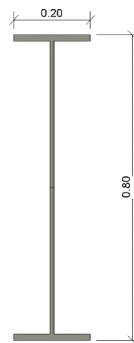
Sección de la viga BOYD compuesta por el perfil IPE 500.
